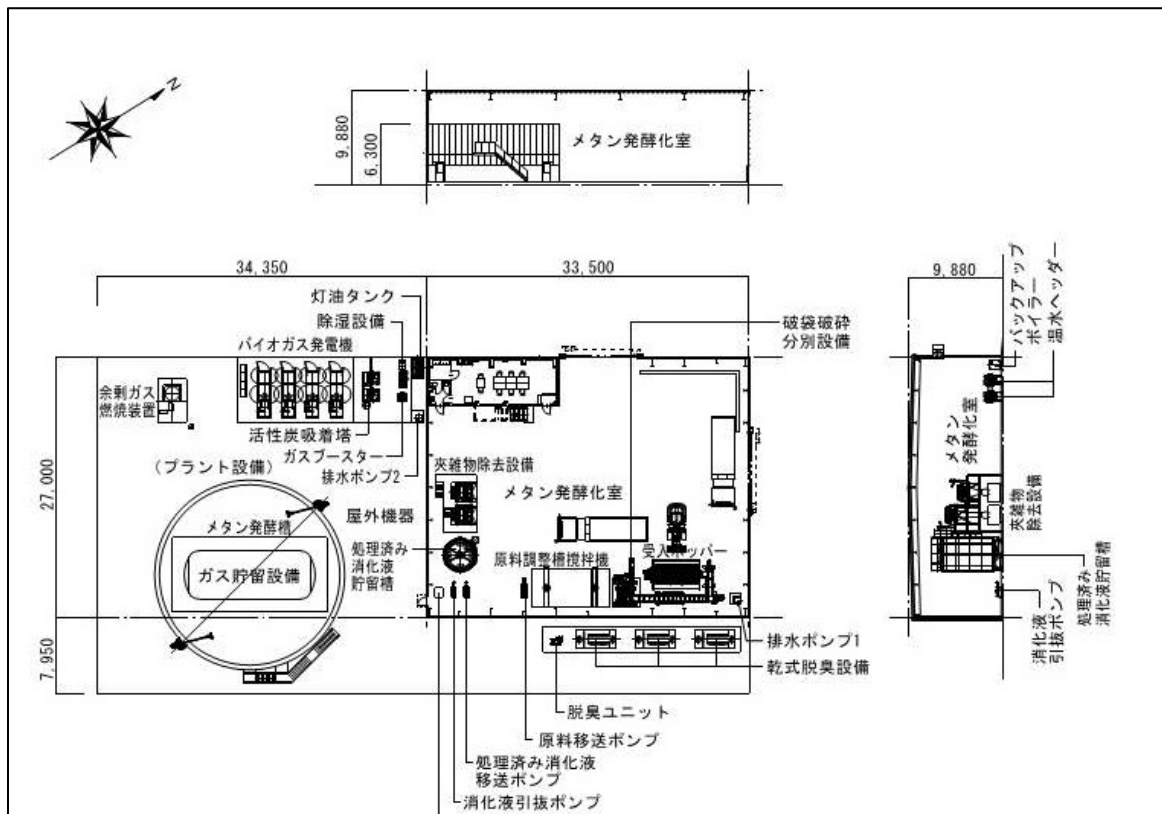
(1) 設備機器の平面図（エネルギー回収施設（メタン発酵施設））
